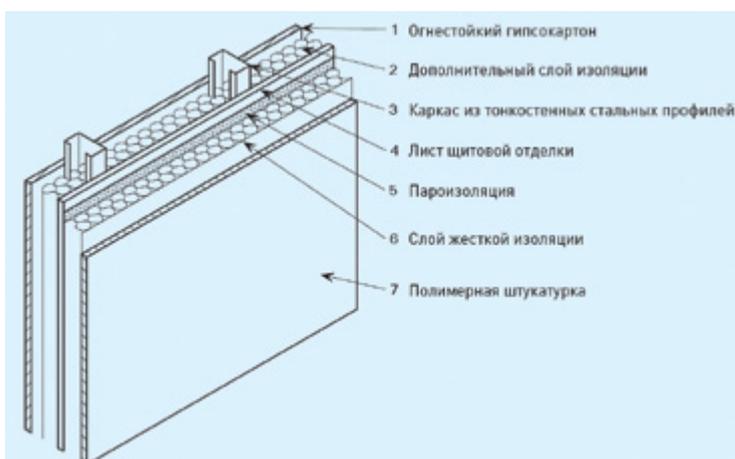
Типовая фасадная конструкция со штукатуркой по утеплителю.
